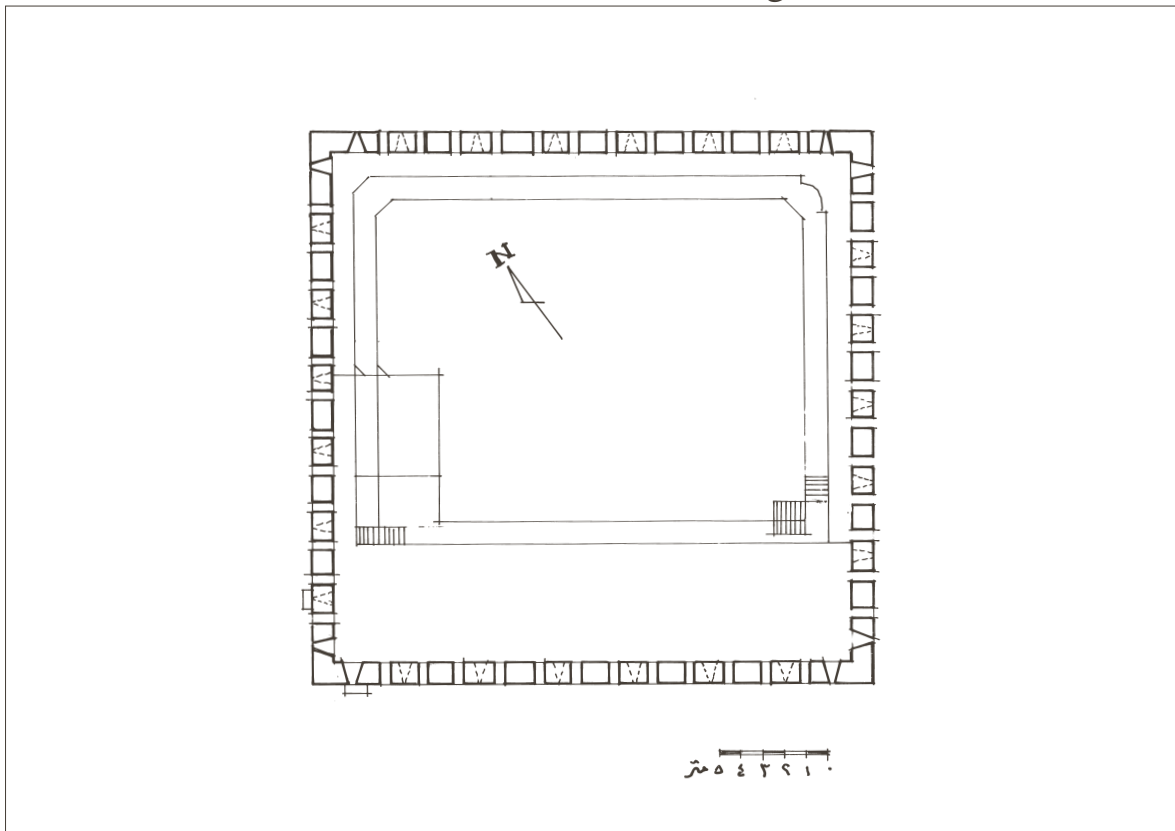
مسقط أفقي للطابق الأرضي من قلعة ذات الحاج.
